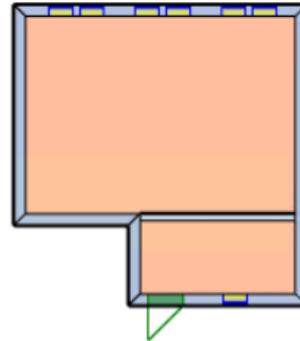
Grundriss Kellergeschoss, zonierte
